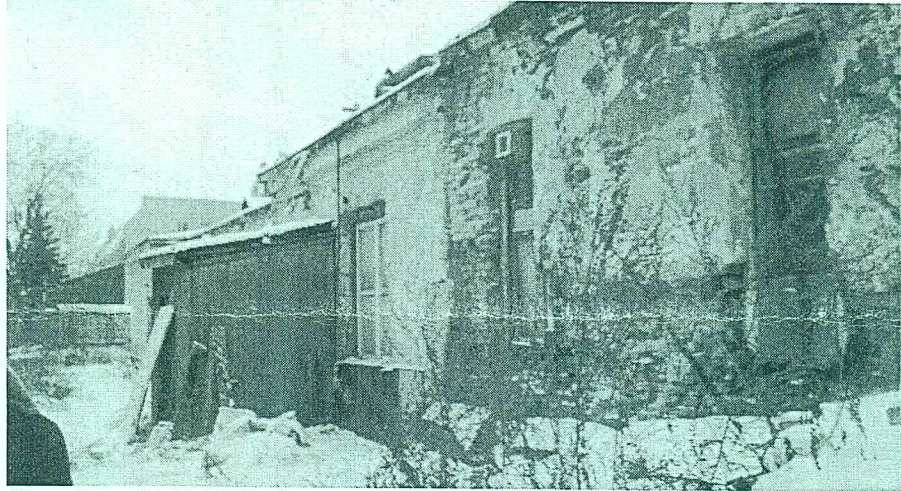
от 24.11.2015. Северо-восточный фасад. Поверхность стен со следами многочисленных повреждений: массовое отслоение и обрушение штукатурного слоя, до оголения кирпичной кладки; обрушение наружной версты кирпичной кладки стен; окрасочный слой здания поврежден полностью.
